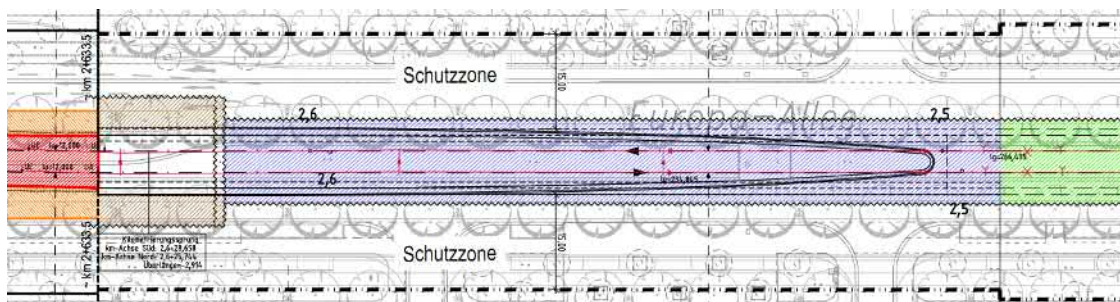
Grundriss des Trogbauwerkes, Geländeoberfläche
